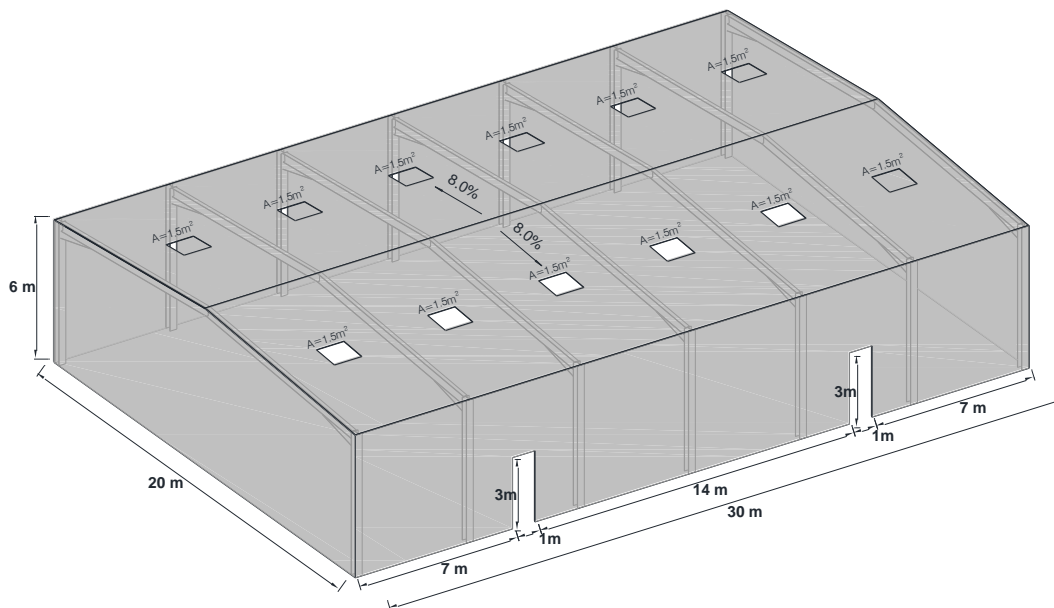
Aberturas na fachada e cobertura consideradas para as simulações realizadas
